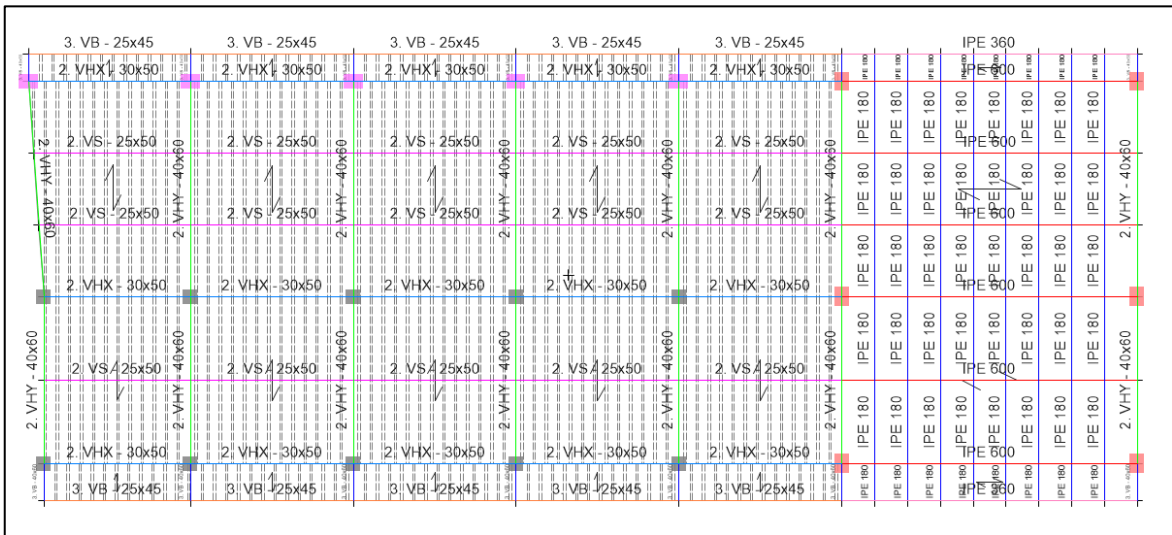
Planta tipo P2 a Cubierta, N.E. +7.20 m a 14.40 m (Castillo & Peñaloza, 2022)
